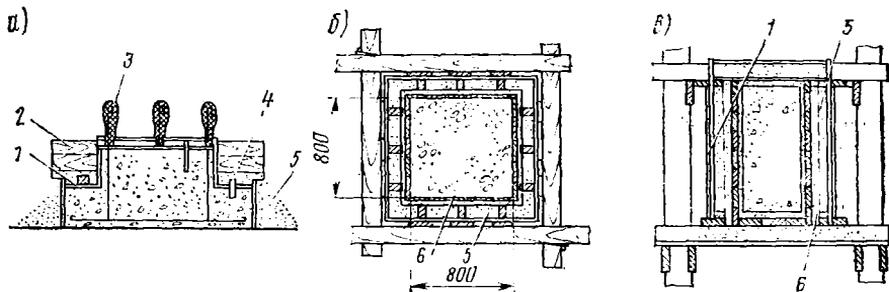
Разрезы устройства теплограждения забетонированных конструкций опоры:
